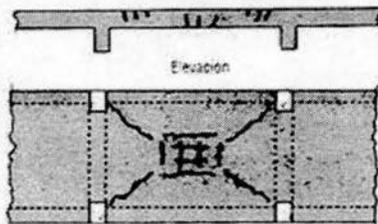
Fisuras de fraguado o falso fraguado
